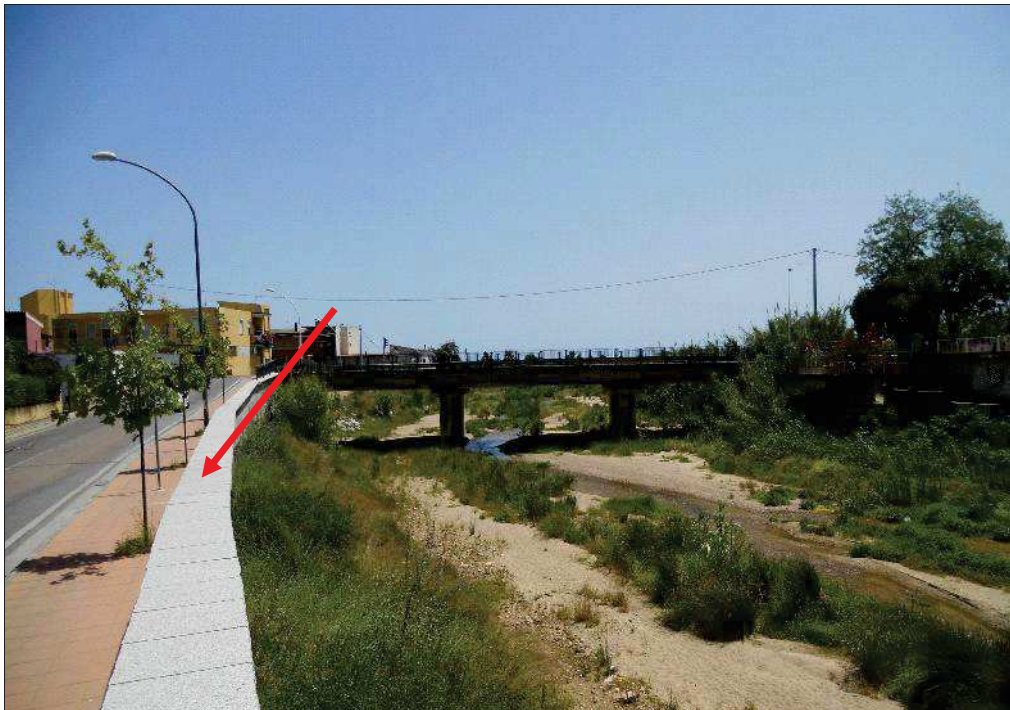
Tratto urbano tra il ponte sulla SS 125 e il ponte di ferro (in primo piano): muro sx di via delle Lavandaie;
